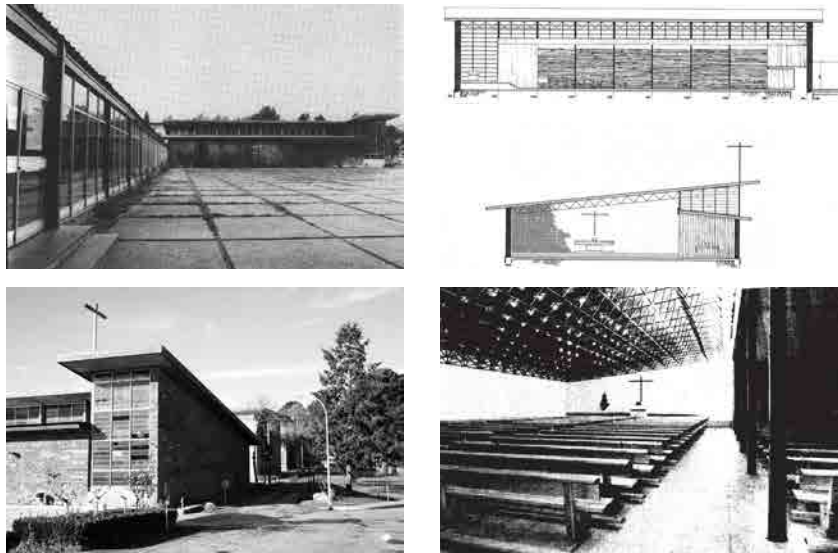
, Fig. 23, Fig. 24, Fig. 25 y Fig. 26 Capilla. Vista de la fachada principal del pabellón al fondo de la plaza de acceso (arriba izquierda, fotografía de época), sección longitudinal y sección transversal (arriba derecha), vista parcial de la fachada (abajo izquierda, fotografía actual) y vista del interior (abajo derecha, fotografía de época).
